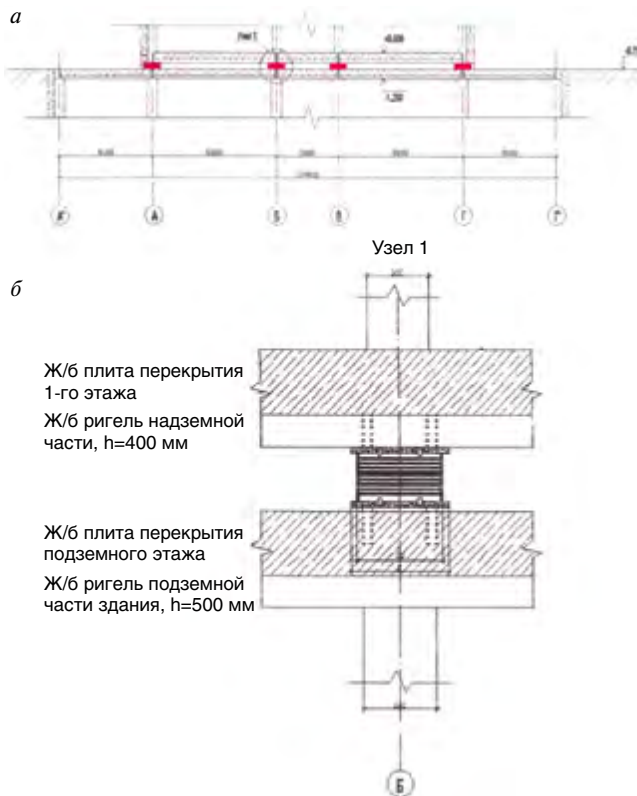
Разрез здания в месте установки опор: а – фрагмент разреза здания; б – узел сопряжения опор с конструкциями
